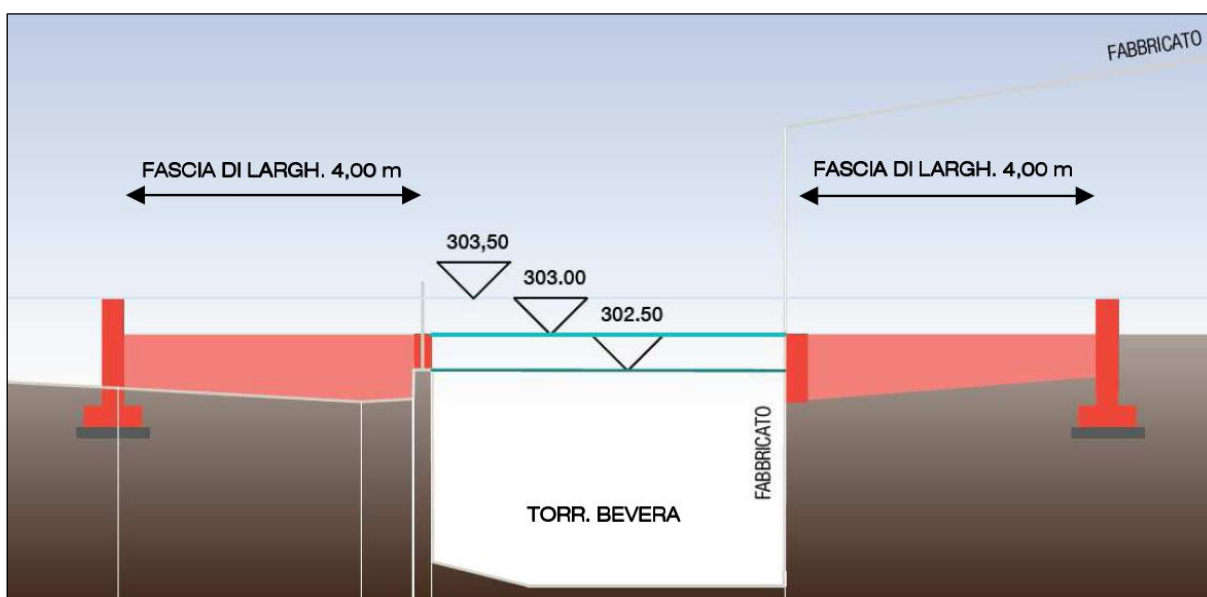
Sezione tipologica del rilevato arginale prevista nell'area di Renate
